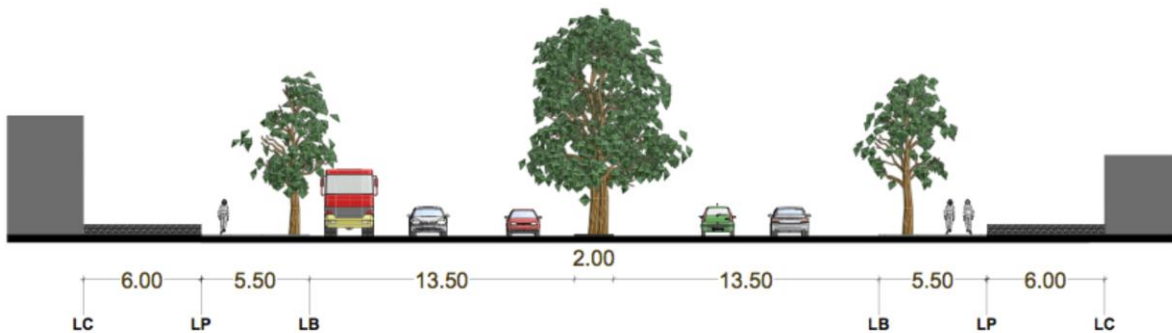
Perfil vía tipo VTM2. Adaptado del POT Barranquilla, 2008.
